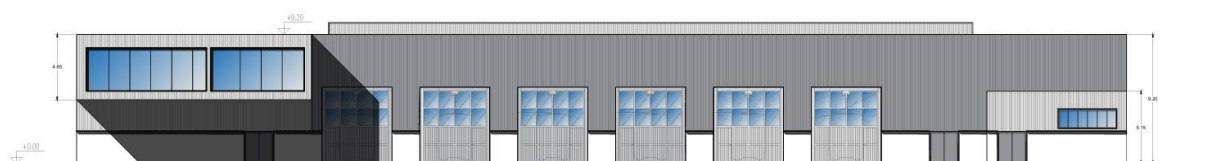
Officina manutenzione rotabili_ Prospetto sud
